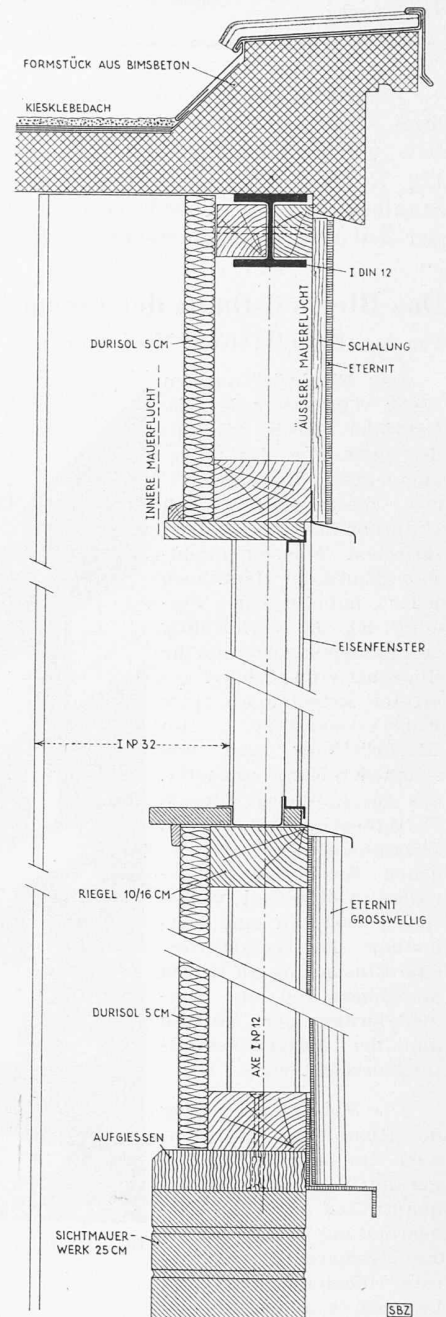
Detail 1:12 der Aussenwandkonstruktion der West- und Nordfassaden
